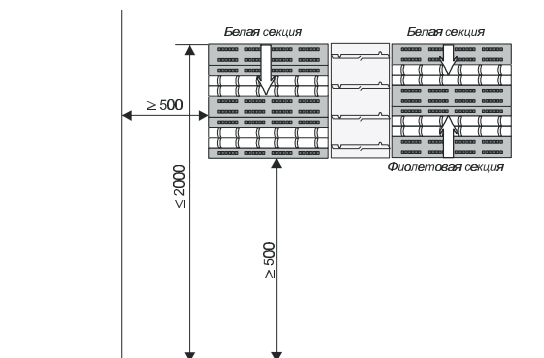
Пример плана размещения коммутационных панелей на стене помещения
